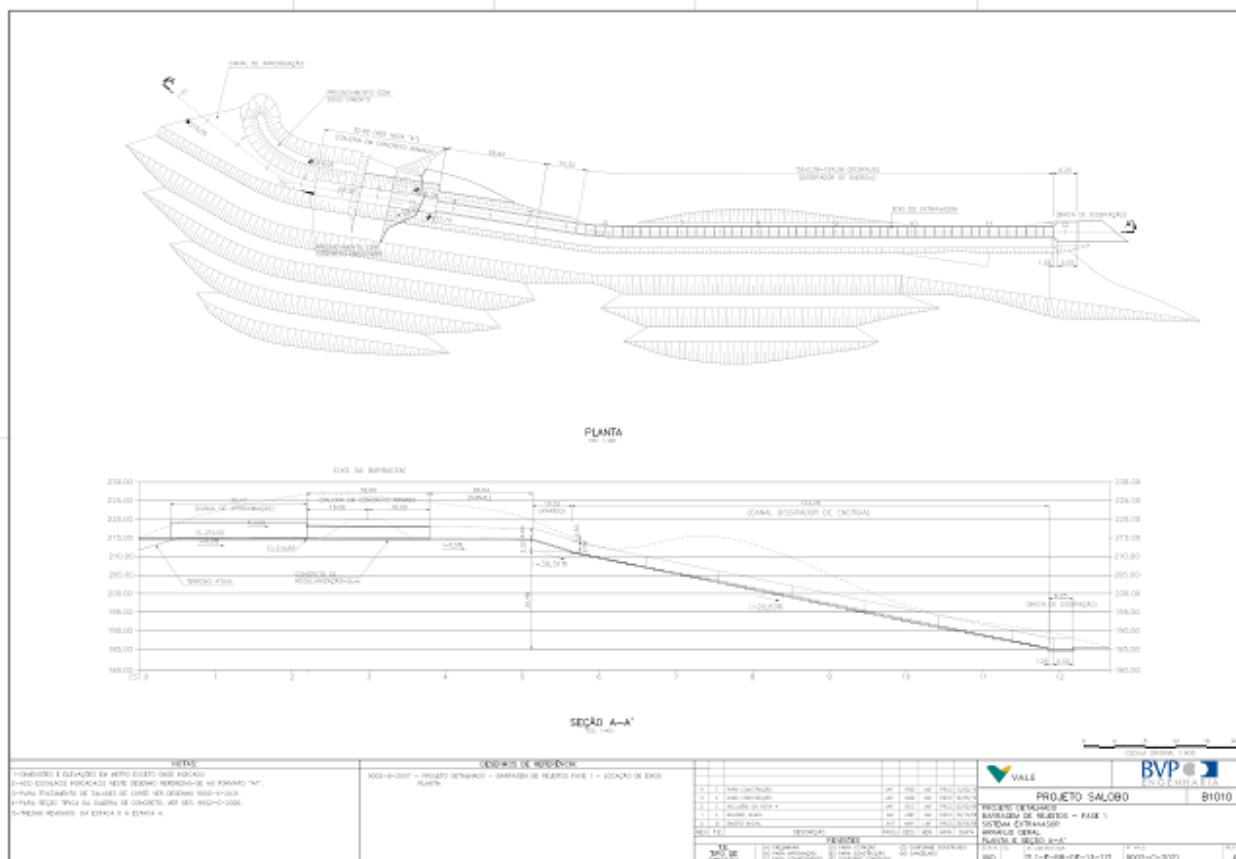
Planta e perfil longitudinal do extravasor da elevação 220,0 m. Reprodução do documento 9002-C-2021.
